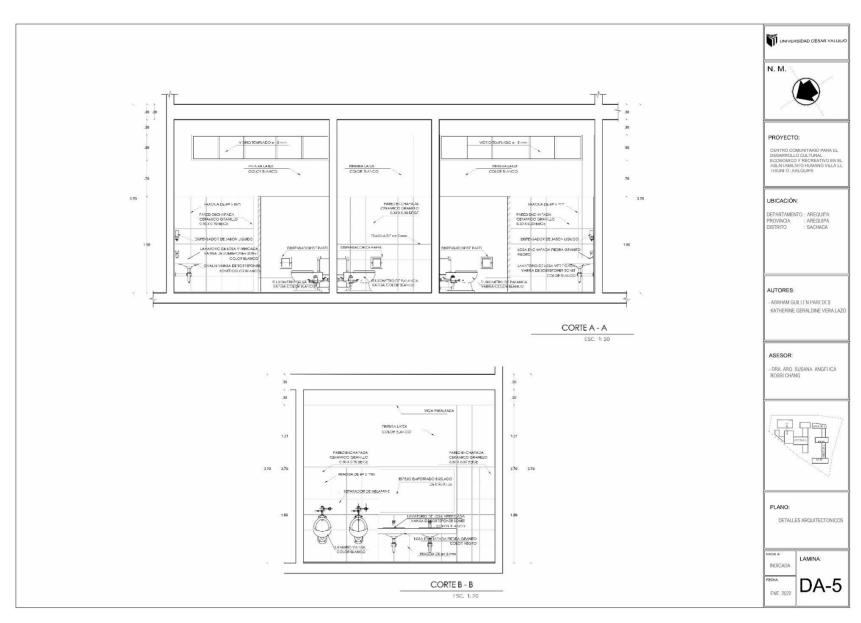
Plano de Detalles Arquitectónicos (Secciones - Baño Biblioteca) - Elaboración propia
